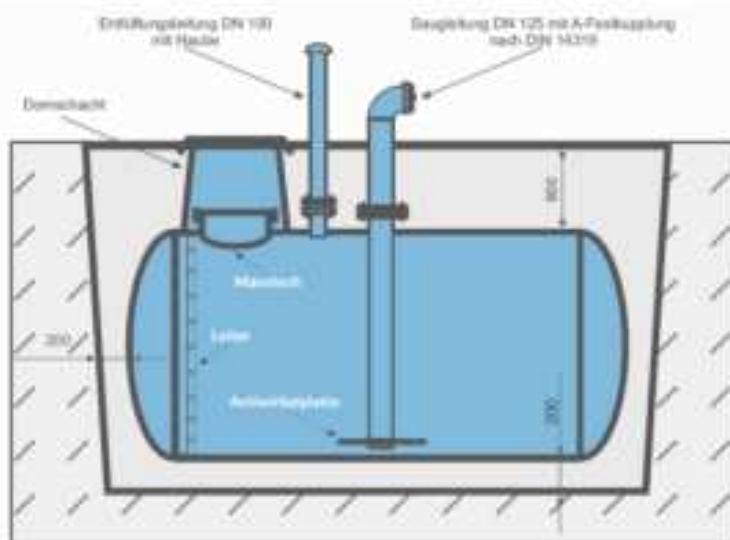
Einbauskizze Erdtank, Quelle: <https://www.loeschwasserbehaelter.de/>
